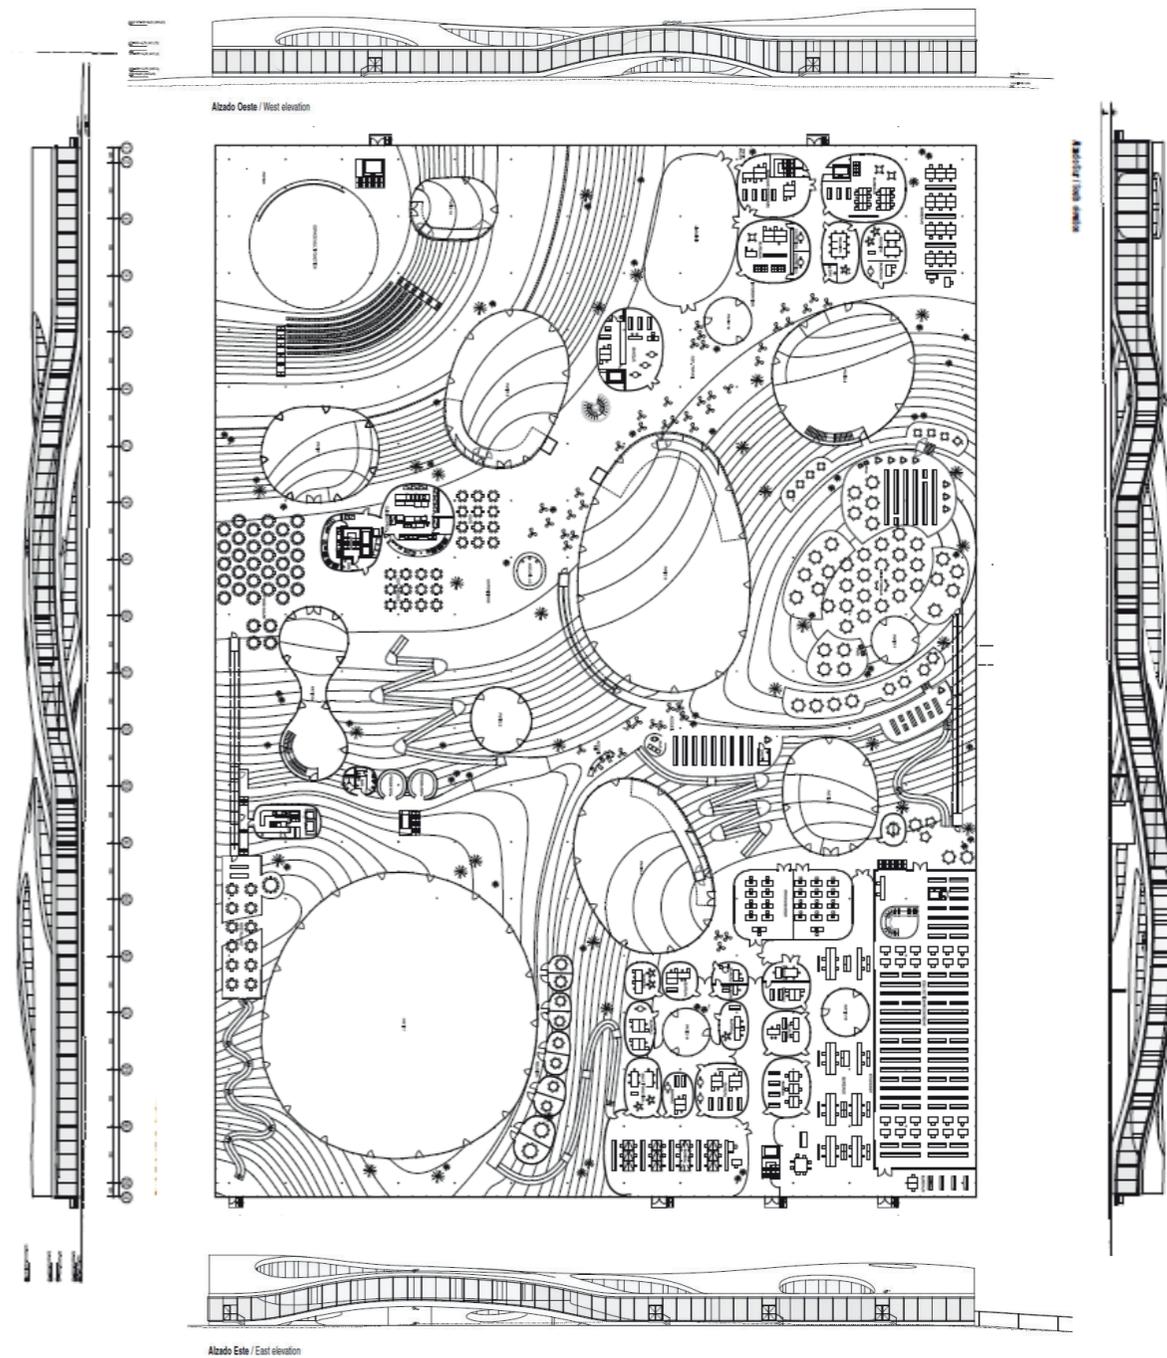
Fotografía centro Rolex. Figura 27: Planimetría original Centro Rolex, SANAA.
